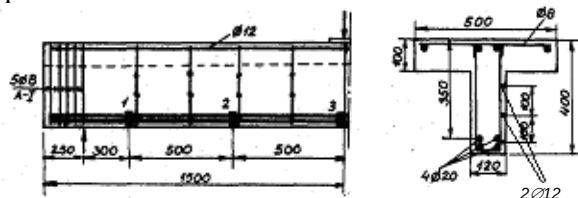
Схема армирования тавровых балок: 1, 2, 3 – места установки тензорезисторов.
